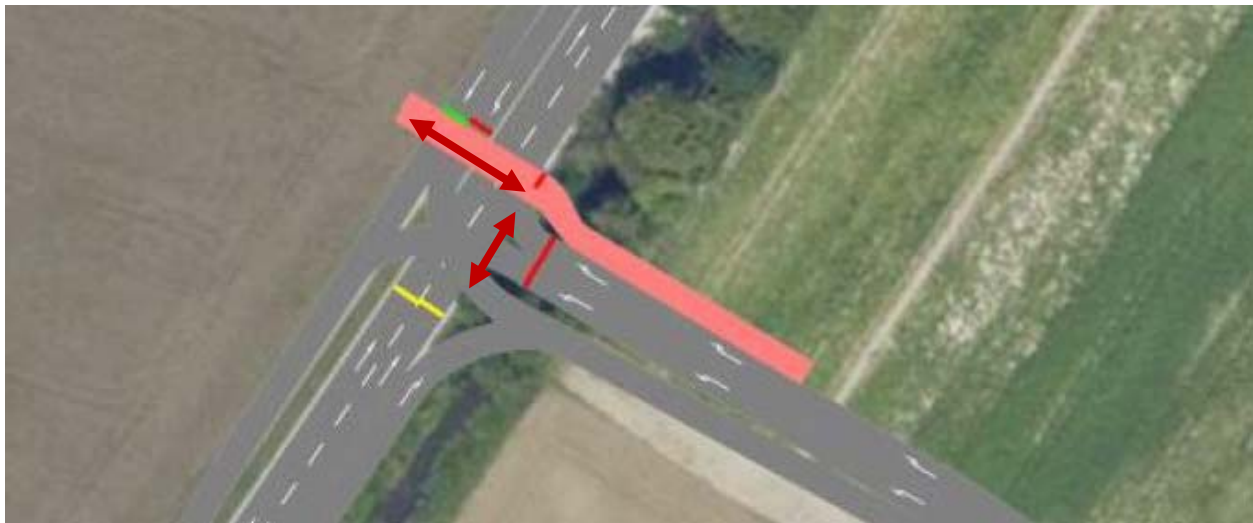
Grober Entwurf signalisierter Knotenausbau B301/ Planstraße Predazzoallee (Obermeyer, 2025) mit zusätzlicher Querungsmöglichkeit über die Planstraße Predazzoallee
